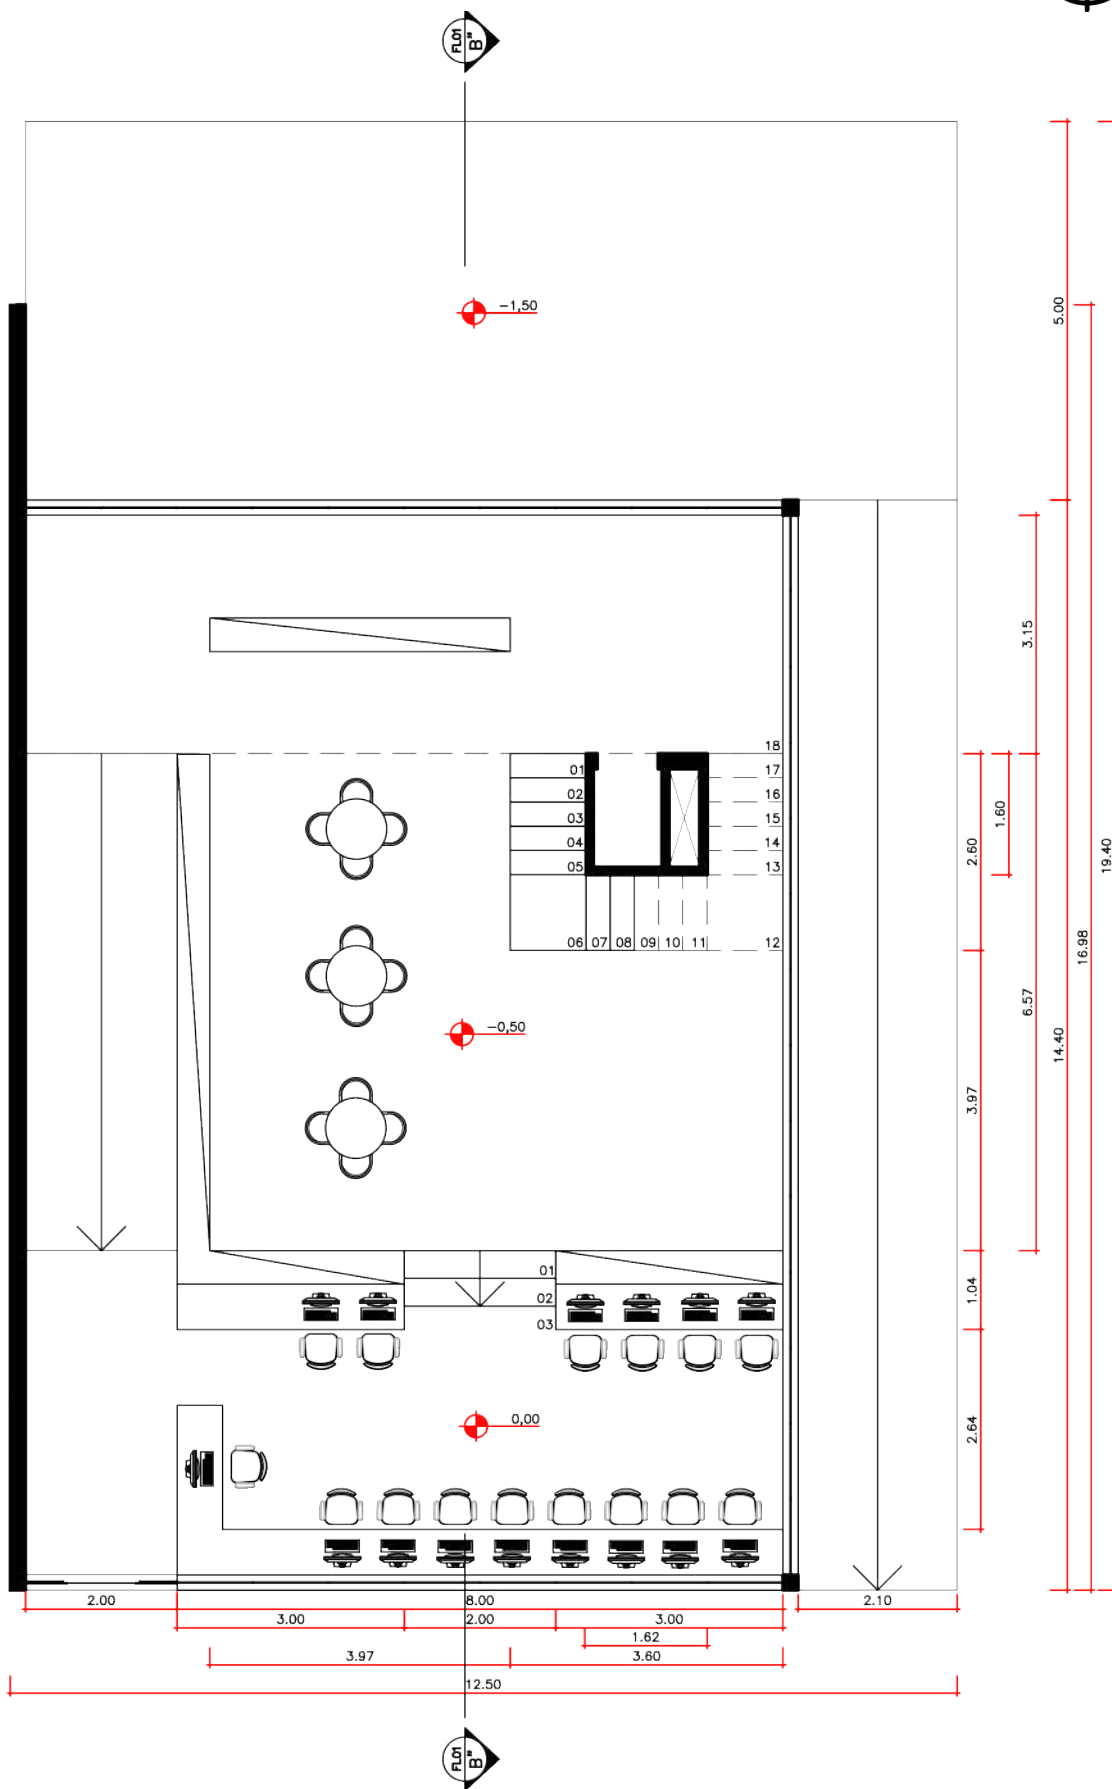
BLOCO DA BIBLIOTECA - PLANTA TÉRREA - ESC.: 1:100
